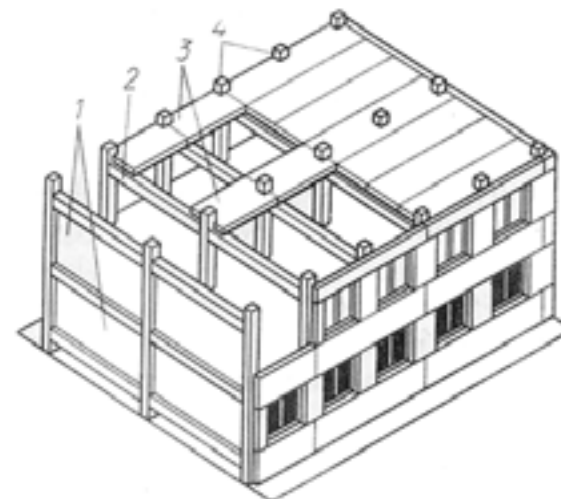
Элементы, обеспечивающие пространственную жесткость каркасных зданий: 1 – стенки жесткости, 2 – ригели, 3 – панели-распорки, 4 – колонны
